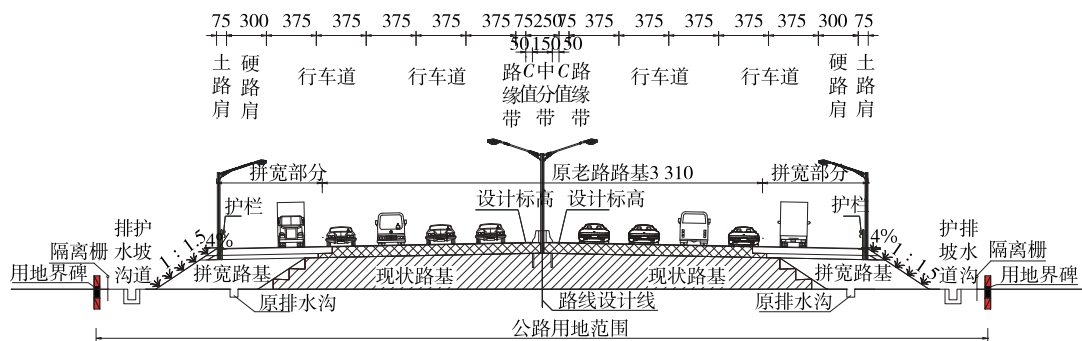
整体式双向十车道 49 m 断面方案(单位:cm)
